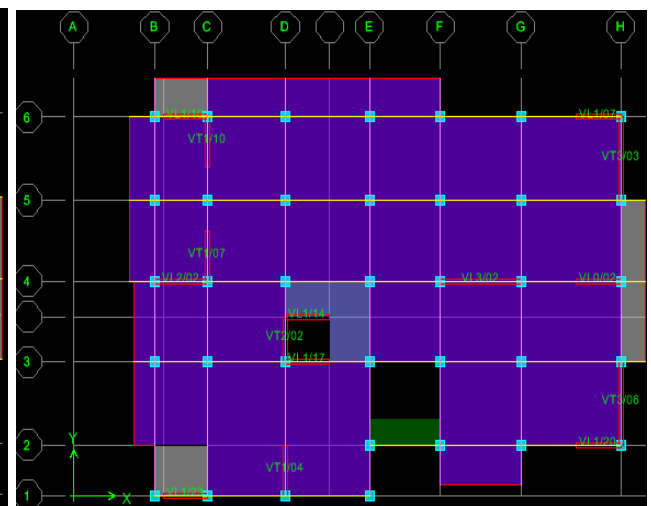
Vue en plan des éléments structuraux d'un 1^{er} étage
